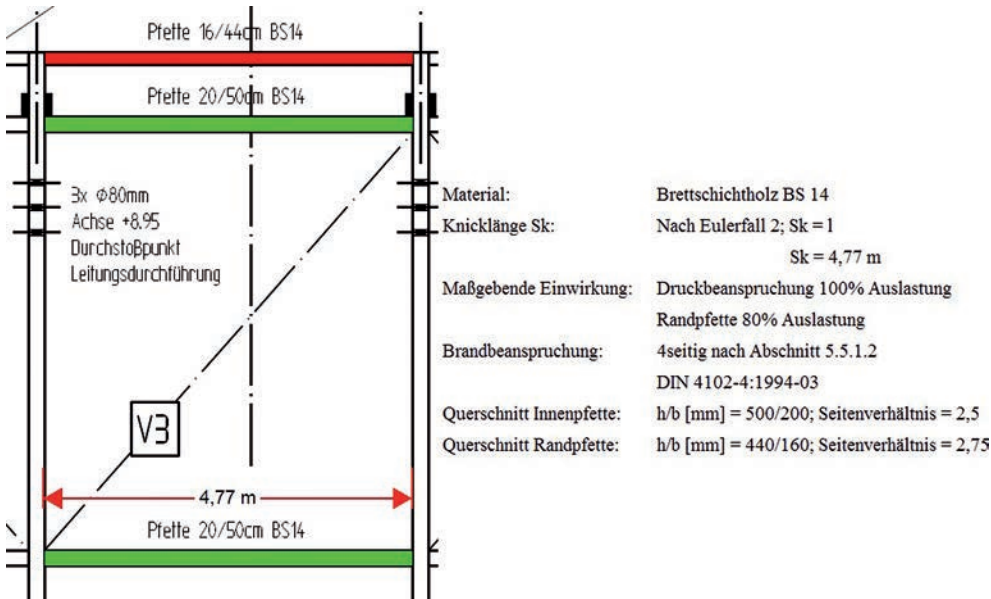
Ausschnitt Grundriss mit Darstellung der Innen- und Randpfetten; Eingangswerte für konstruktiven Brandschutznachweis auf Grundlage der Tab. 78 zur DIN 4102-4:1994-03 [6]
